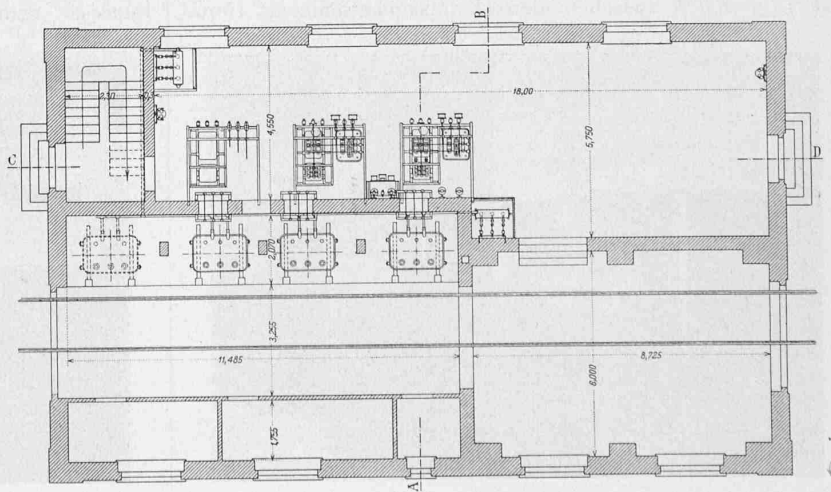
Grundriss vom Erdgeschoss. — Masstab 1 : 200.
